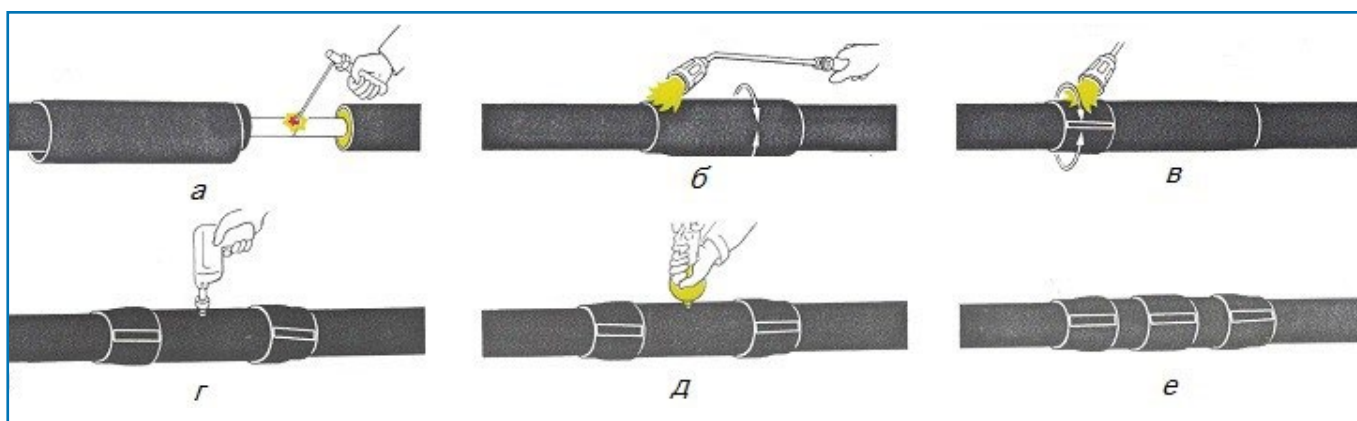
Некоторые стадии процесса заделки стыка труб с ППУ-изоляцией с помощью термоусадочной ПЭ-муфты: а – установка муфты на одну из труб и сварка стальных труб; б – продвижение муфты на место стыка и прогрев её краёв для термоусадки; в – наложение термоусадочной ленты на края муфты и фиксатора концов ленты с последующей её термоусадкой с помощью газовой горелки; г – сверление отверстия в муфте; д – заполнение полости в зоне стыка вспенивающейся ППУ-композицией; е – изоляция отверстия с помощью пробки и термоусадочной ленты.
